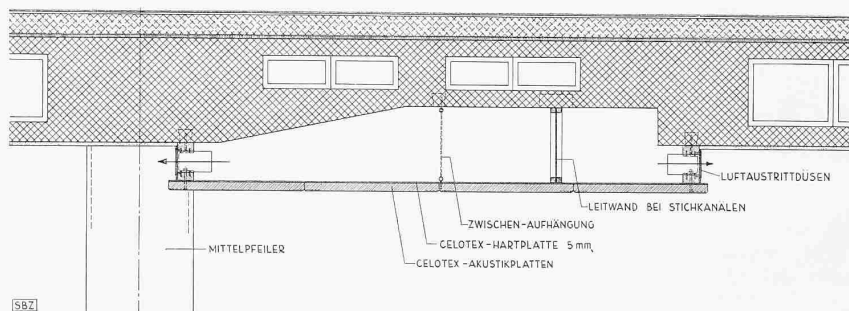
Deckenschnitt mit angehängtem Zuluftkanal. — Masstab 1:20
